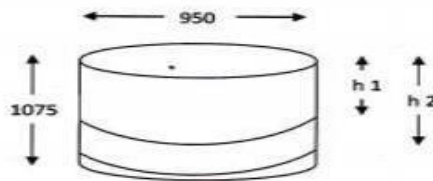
Penggunaan Sumur Resapan dengan Beton Precast berporous dilapisi ijuk
